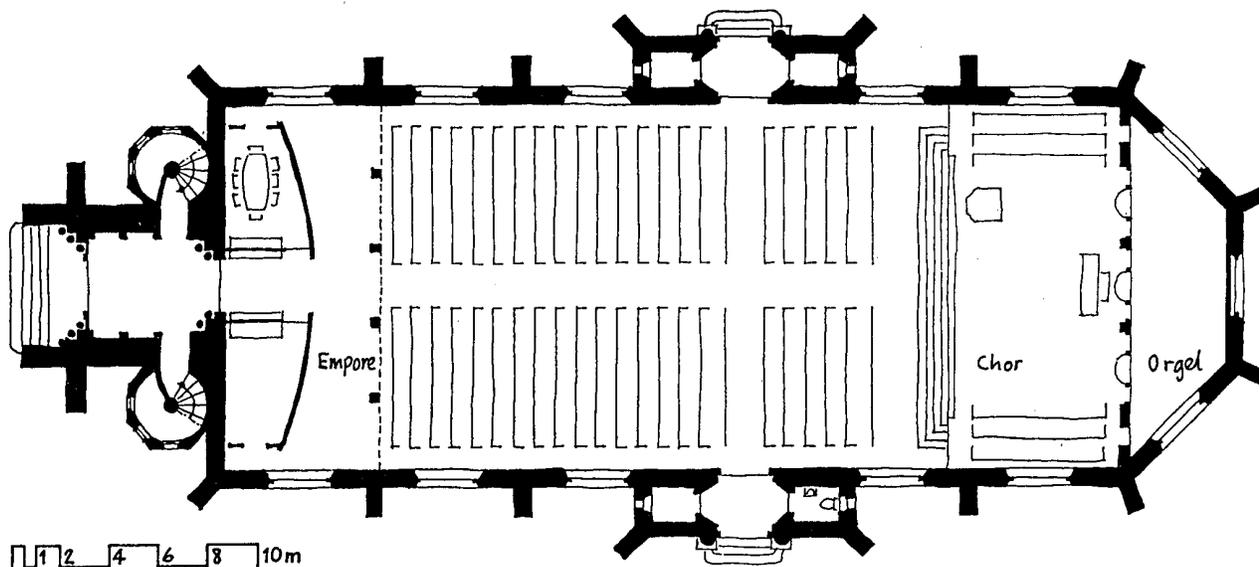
Grundriss evangelische Kirche Amriswil
